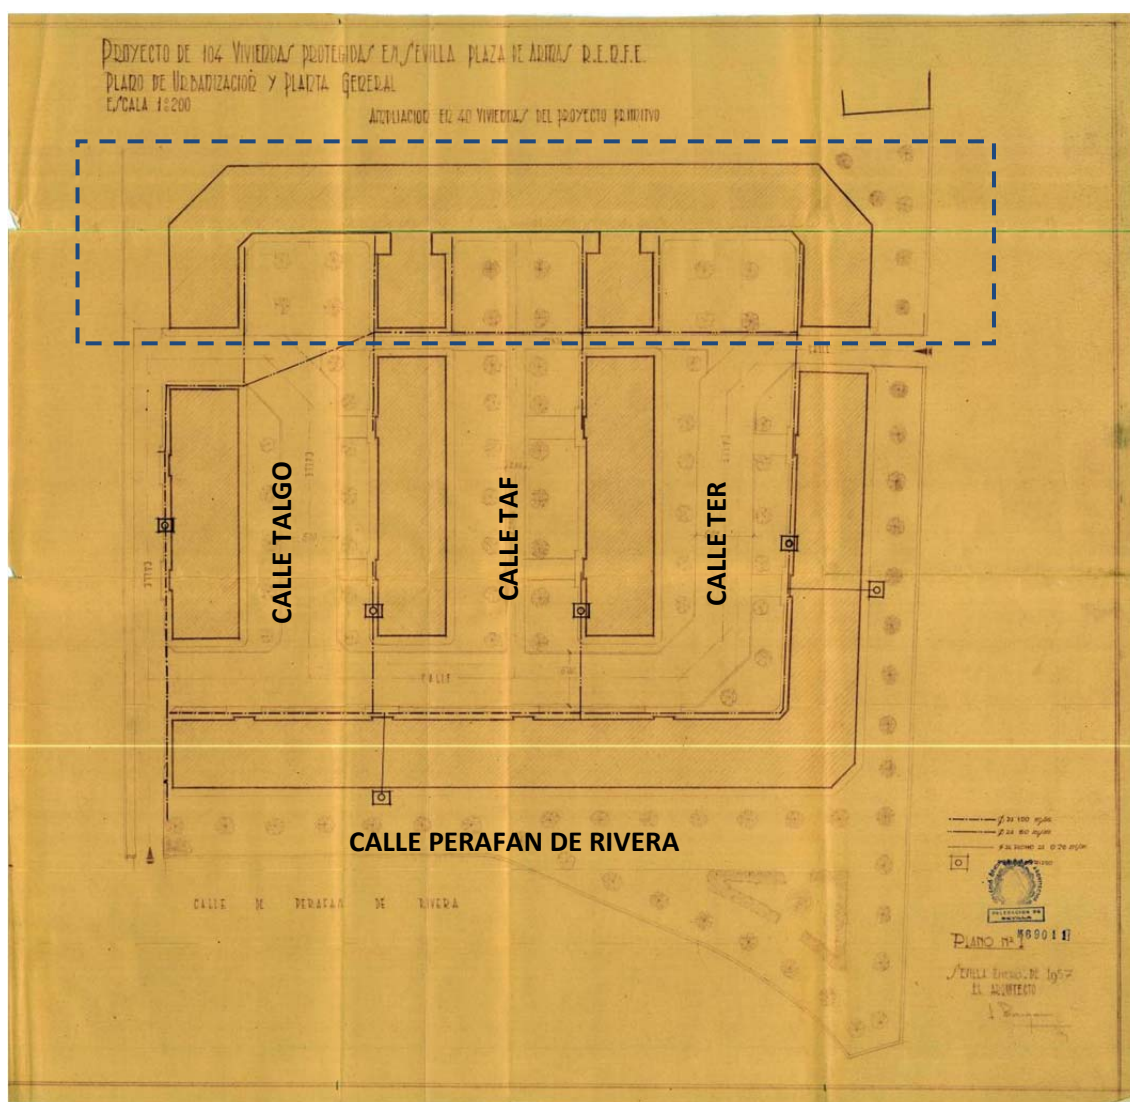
Planta General del Proyecto original. (Archivo Fidas-Coas).
